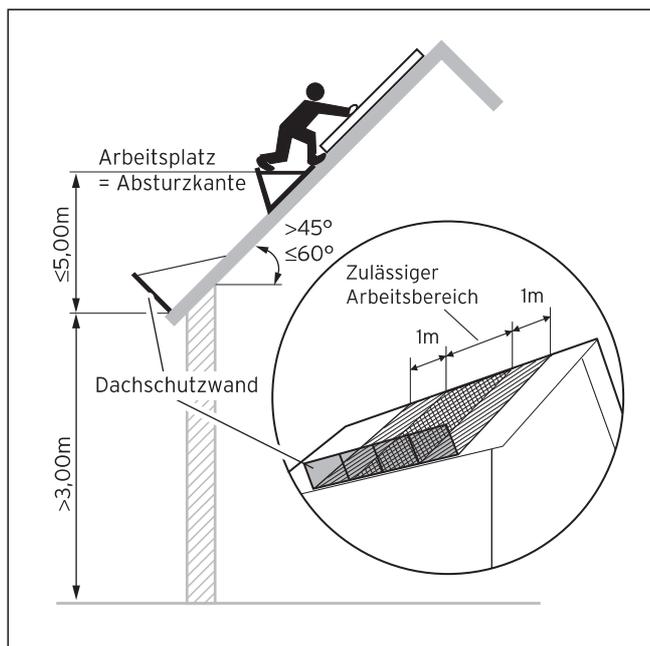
Защитная стенка на кромке для работ на наклонных крышах.
